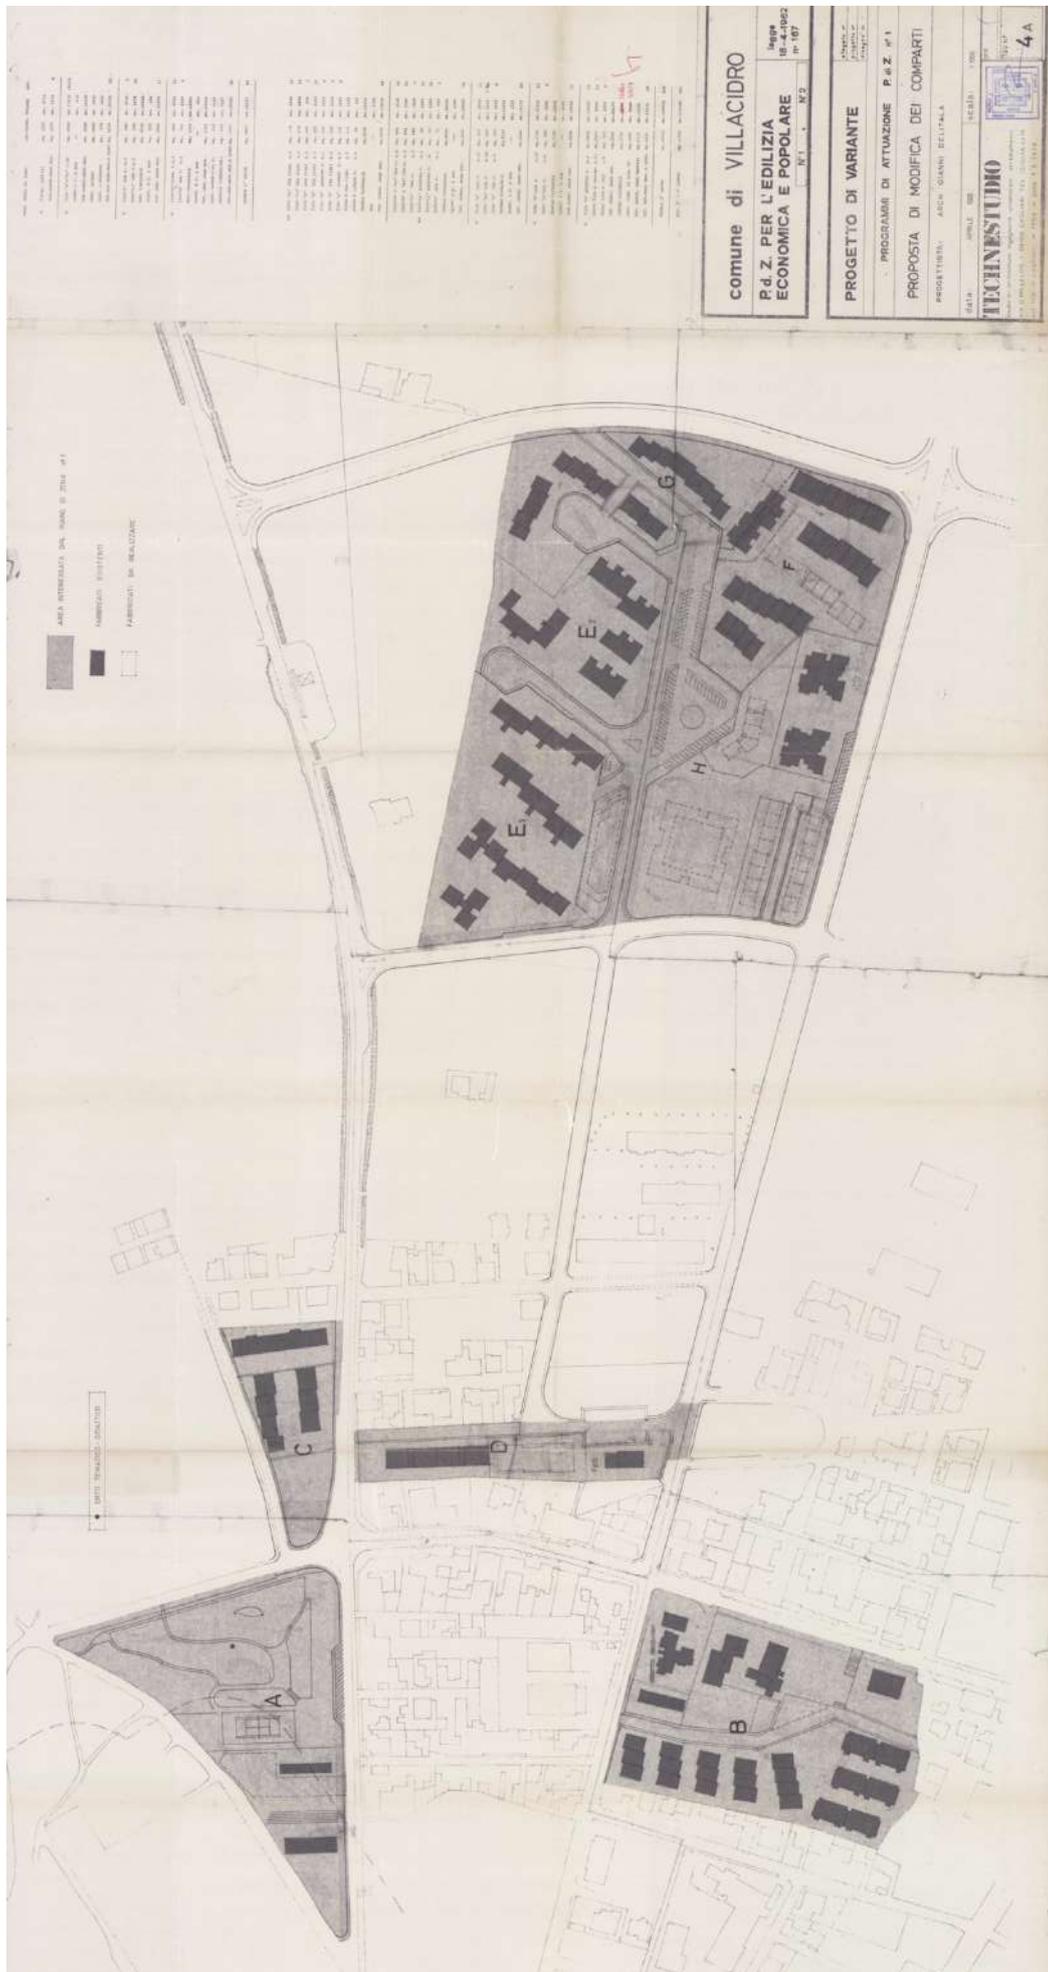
Stralcio planivolumetrico di variante 1995 – Comparto B
